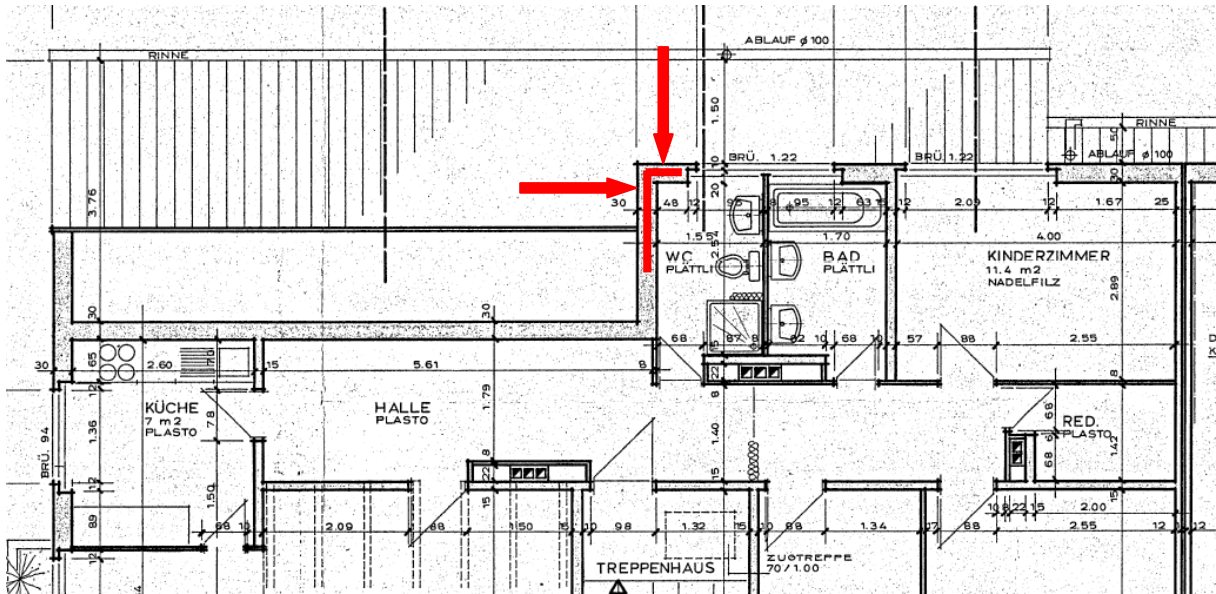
Grundriss mit Wandriss Eckwand WC
